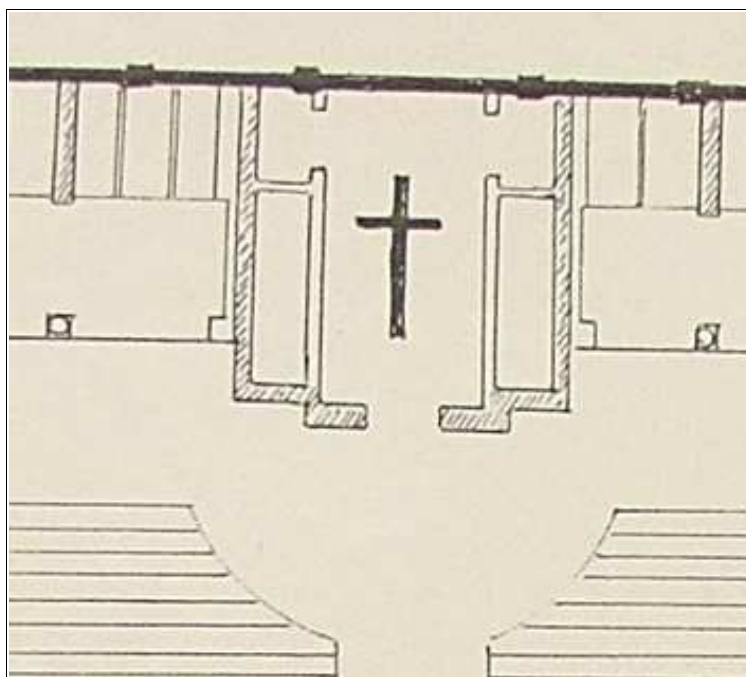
Estratto planimetria di progetto del Piano Regolatore del Cimitero di S. Maddalena – anno 1959
